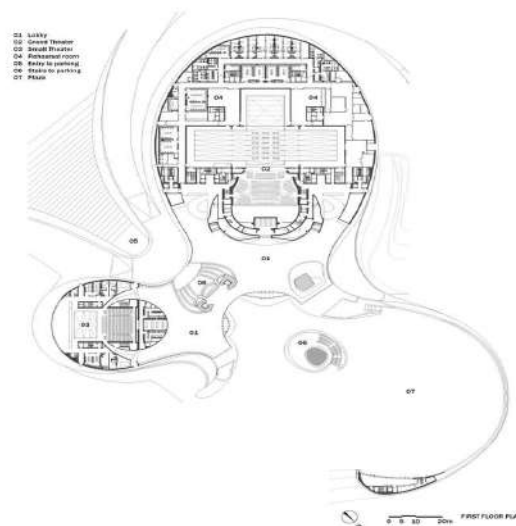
(Planta arquitectónica, ArchDaily, 2015)
